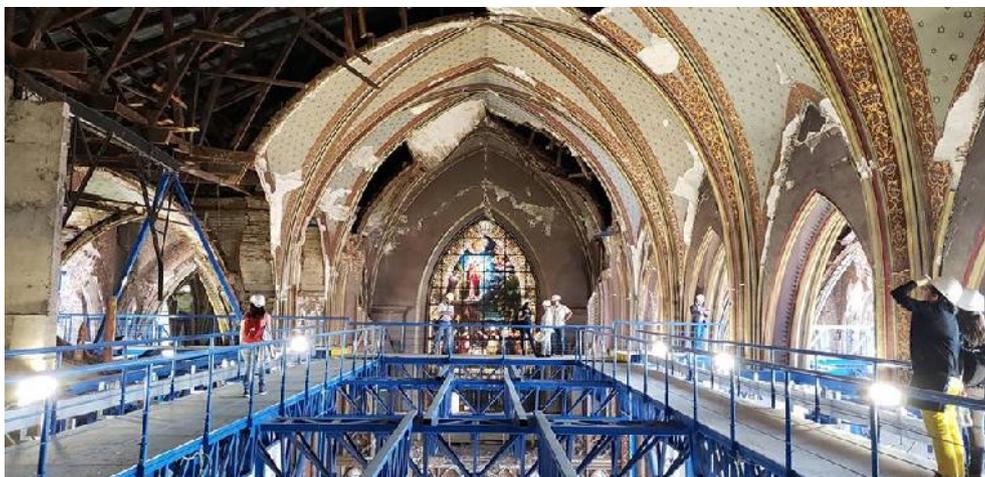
Plataformas de estructura de estabilización de la Basílica del Salvador, interior.
